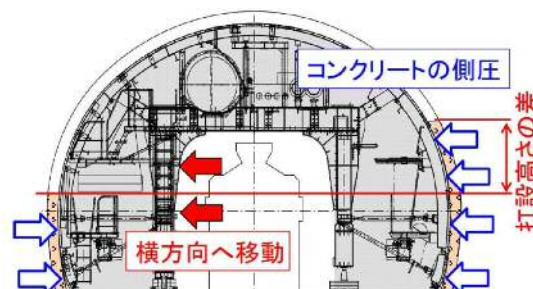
コンクリート側圧によるひび割れ発生 <sup>12)</sup>
